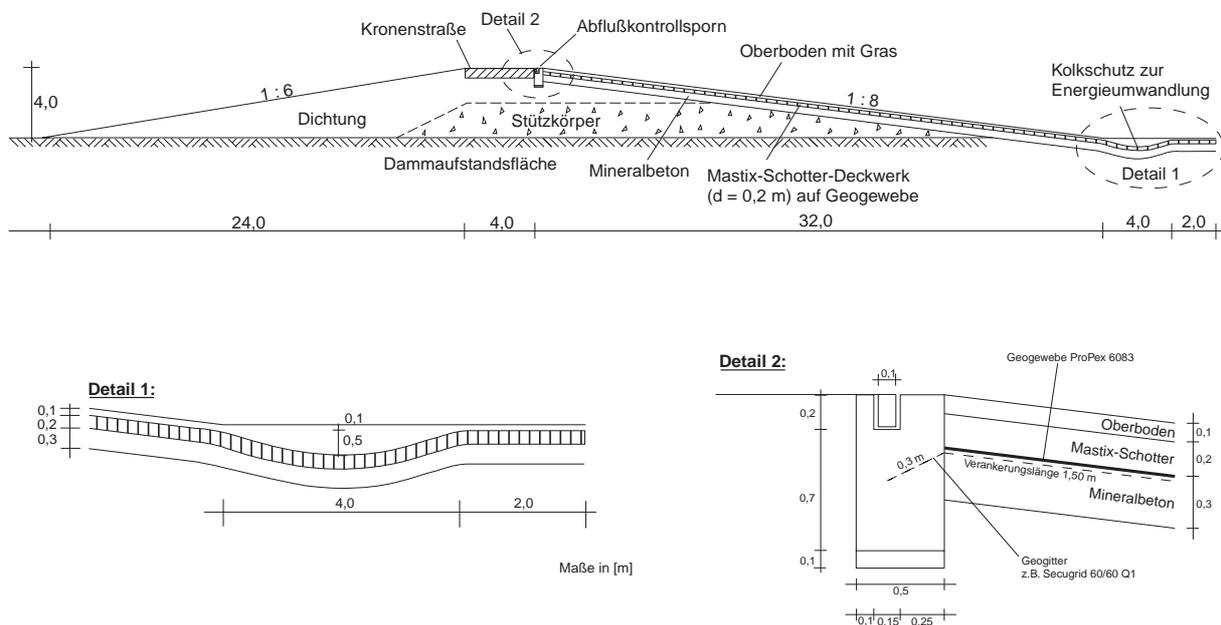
Alternativentwurf für das Hochwasserrückhaltebecken Mönchzell mit Deckwerk aus Mastix-Schotter (spez. hydr. Belastung $q = 405 \text{ l/sm}$)
